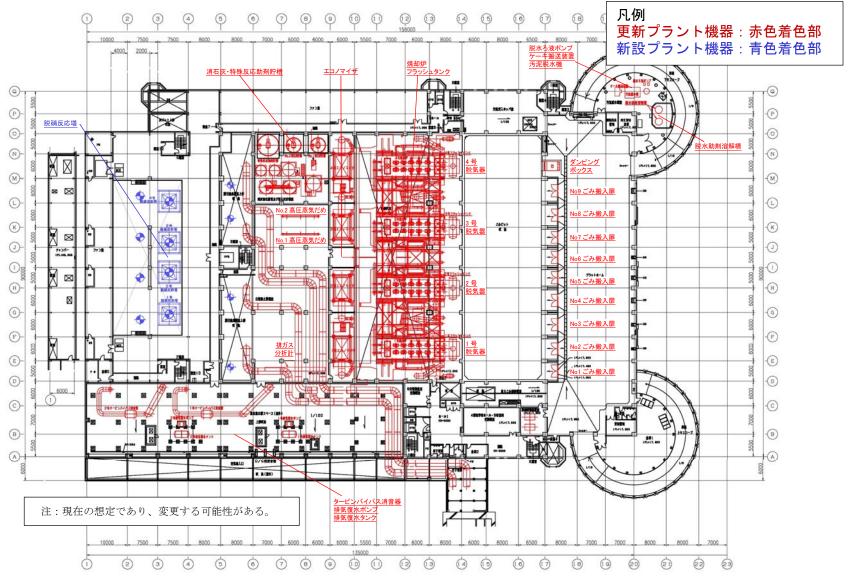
(5) 設備機器の更新箇所(5階平面図)
